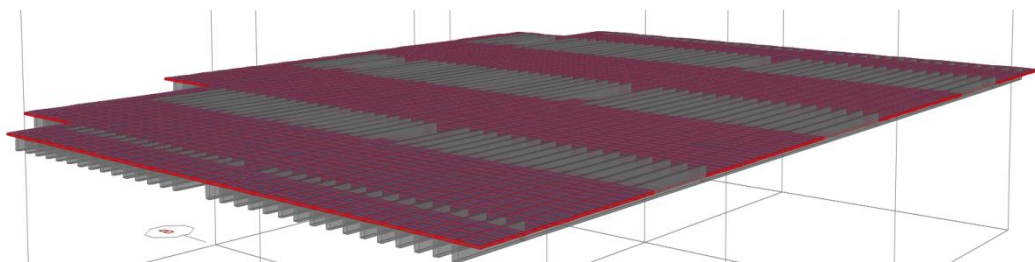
Modelado de vigueta de 30cm y losa maciza de 5cm.
